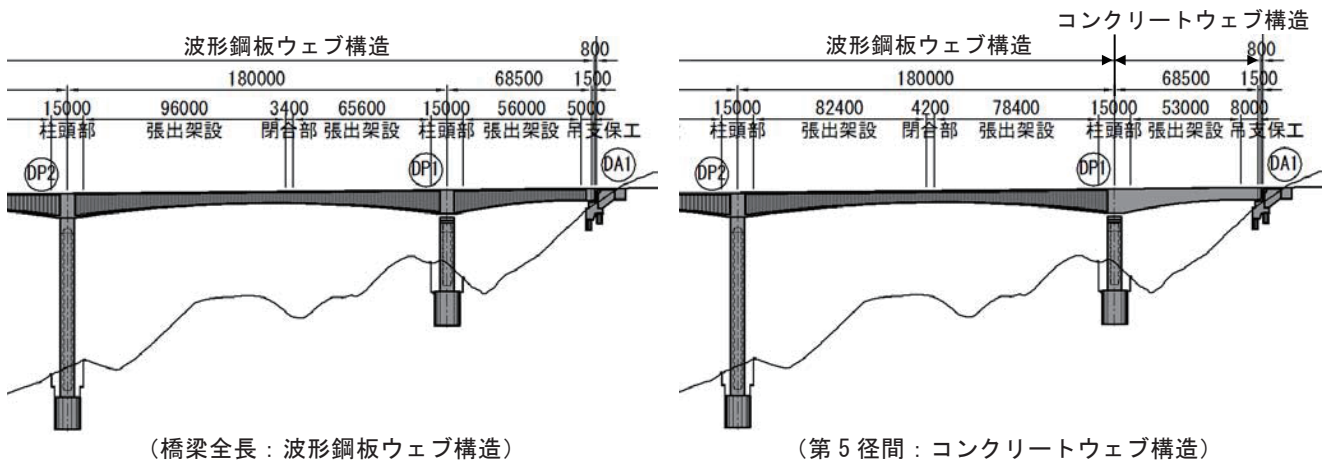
側径間コンクリートウェブ構造による張出し架設長の改善
